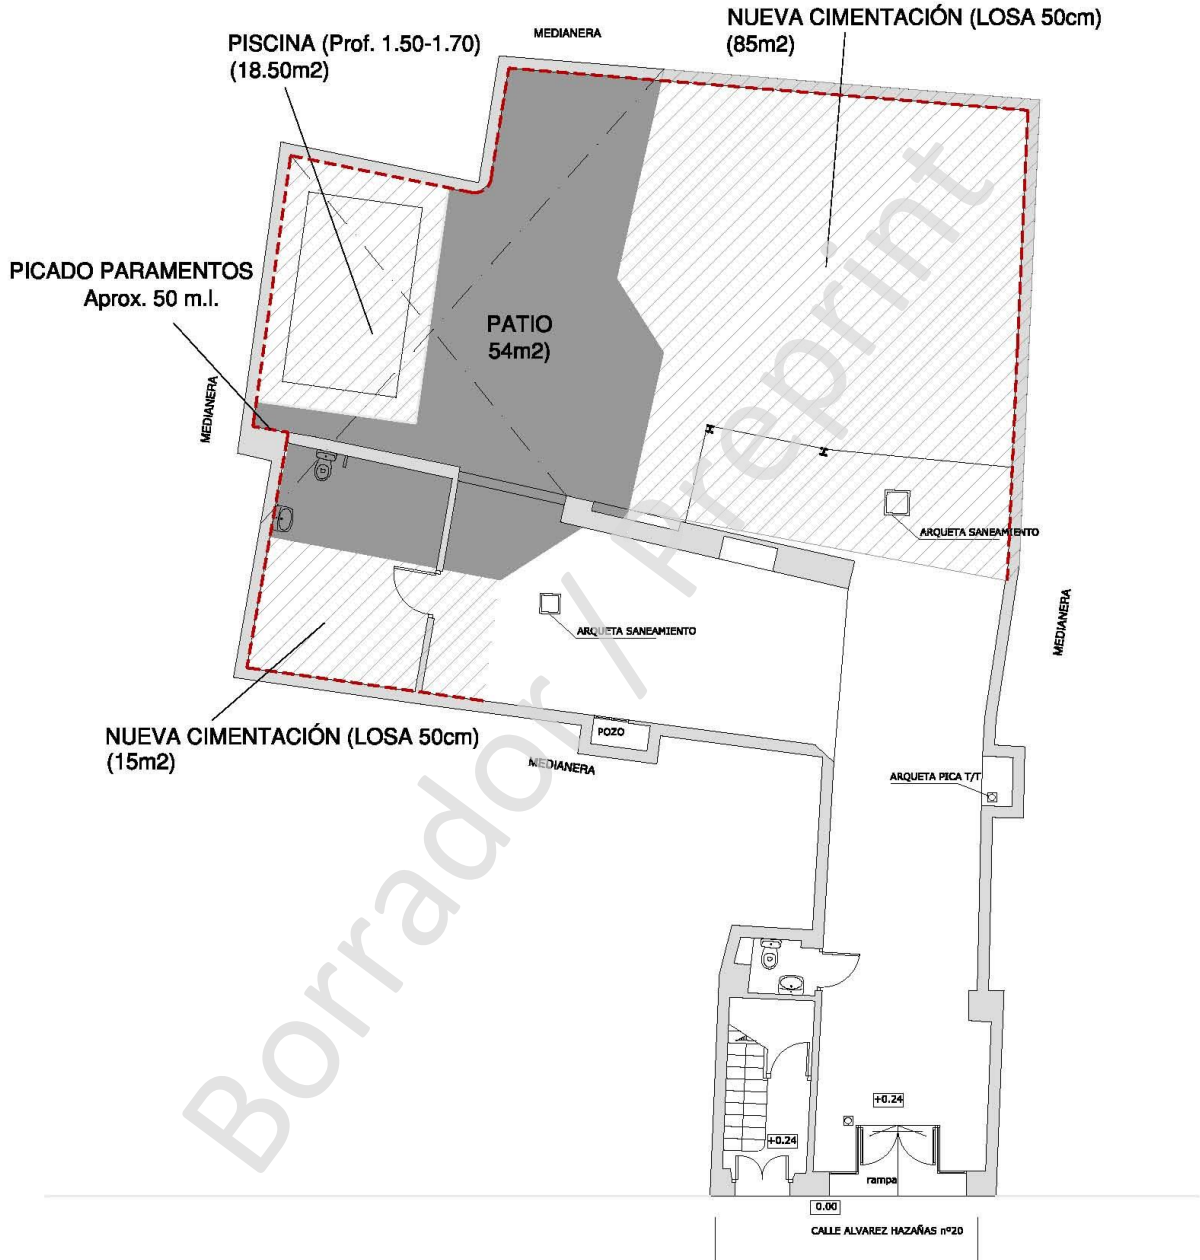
Planta de la parcela con las obras proyectadas (Fuente: Alberto Lima, Arquitecto).
